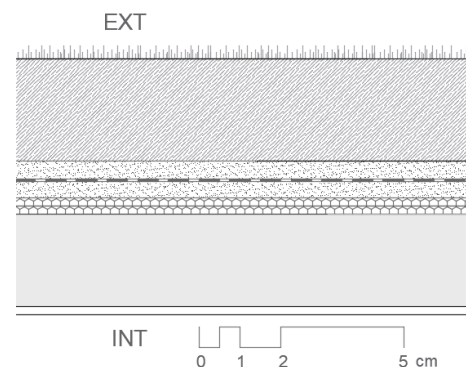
, debajo. Detalle constructivo de la cubierta vegetal del estrato inferior. Autor: autoría propia
